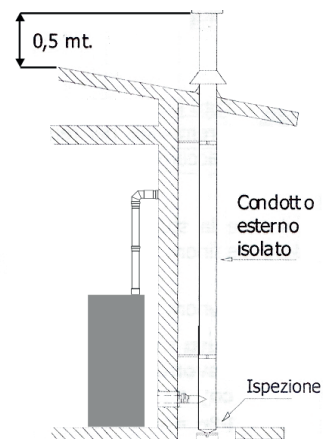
collegamento ad un condotto esterno con tubo isolato o doppia parete
